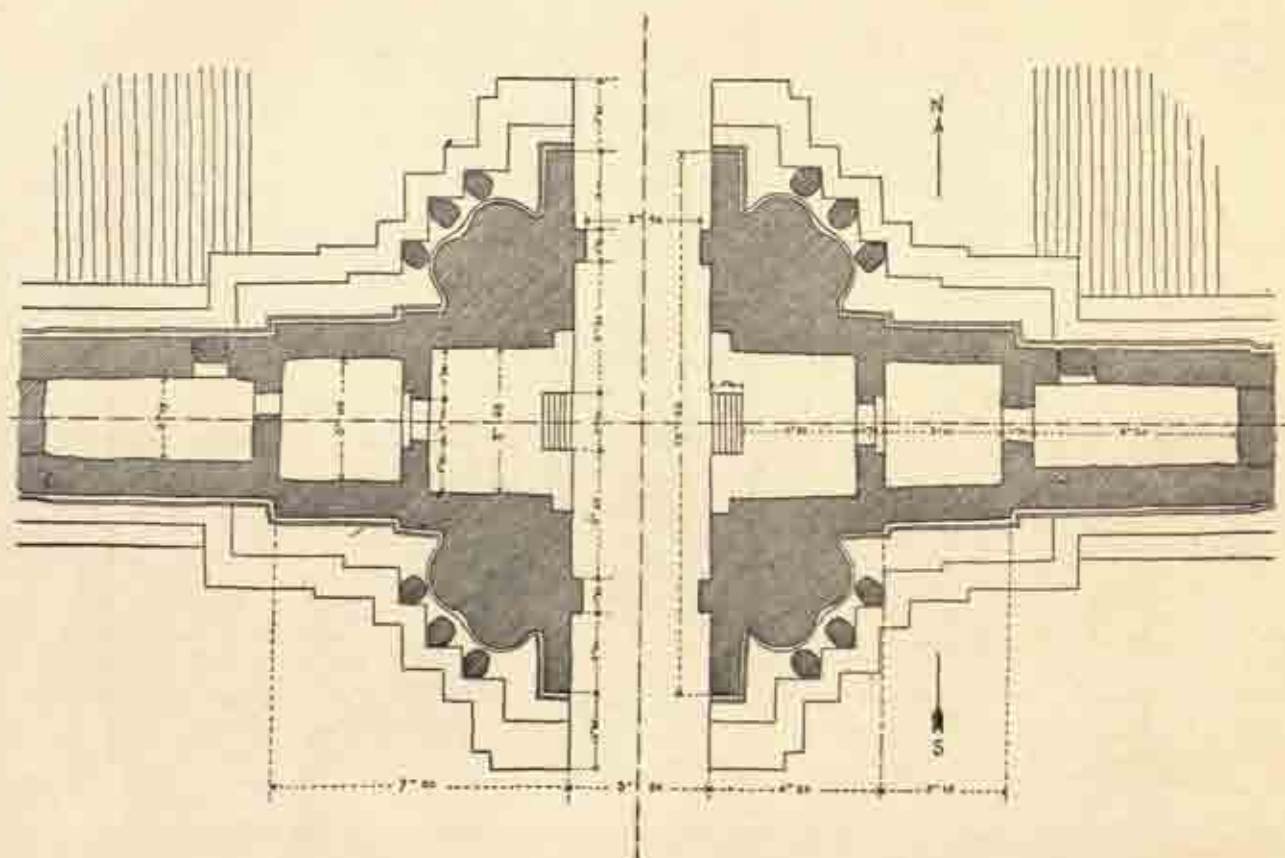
Plan de la porte Sud d'Angkor Thom.
